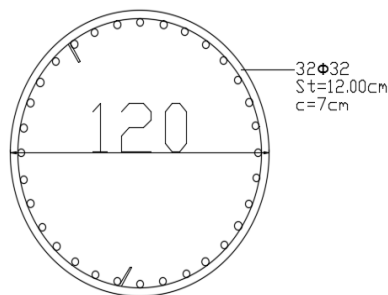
Schéma de ferrailage longitudinal de deux rangées de pieux
